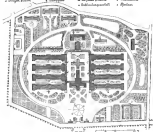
St. Vincent-Hospital in Münster. Lageplan.
